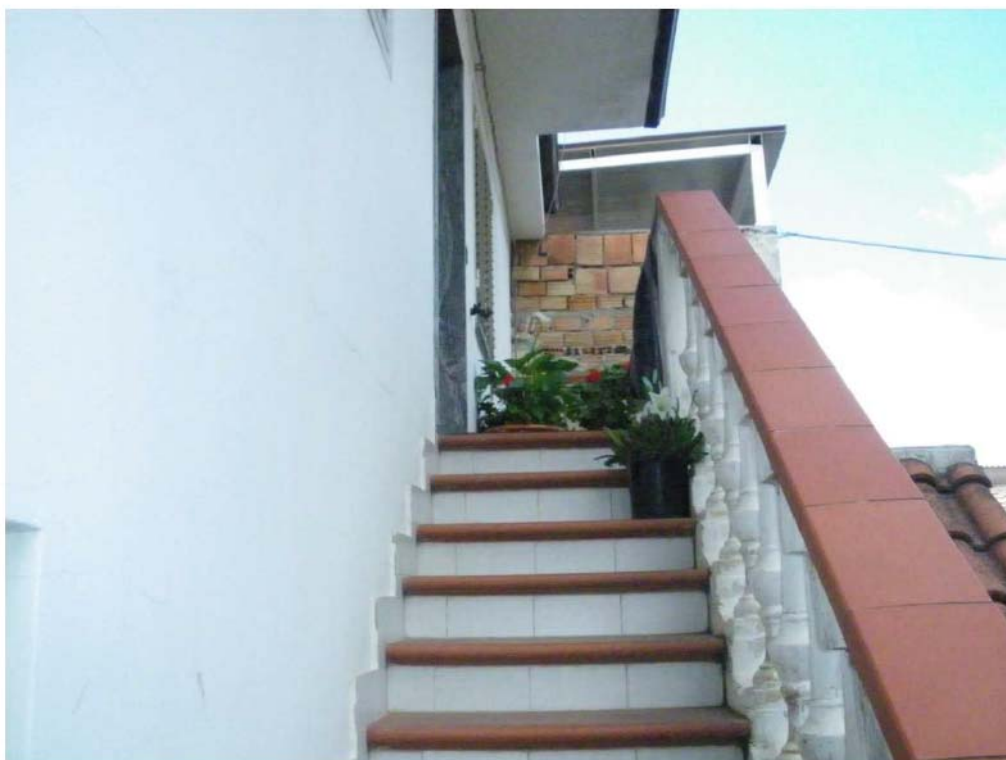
SCALA D'ACCESSO AL PRIMO PIANO
